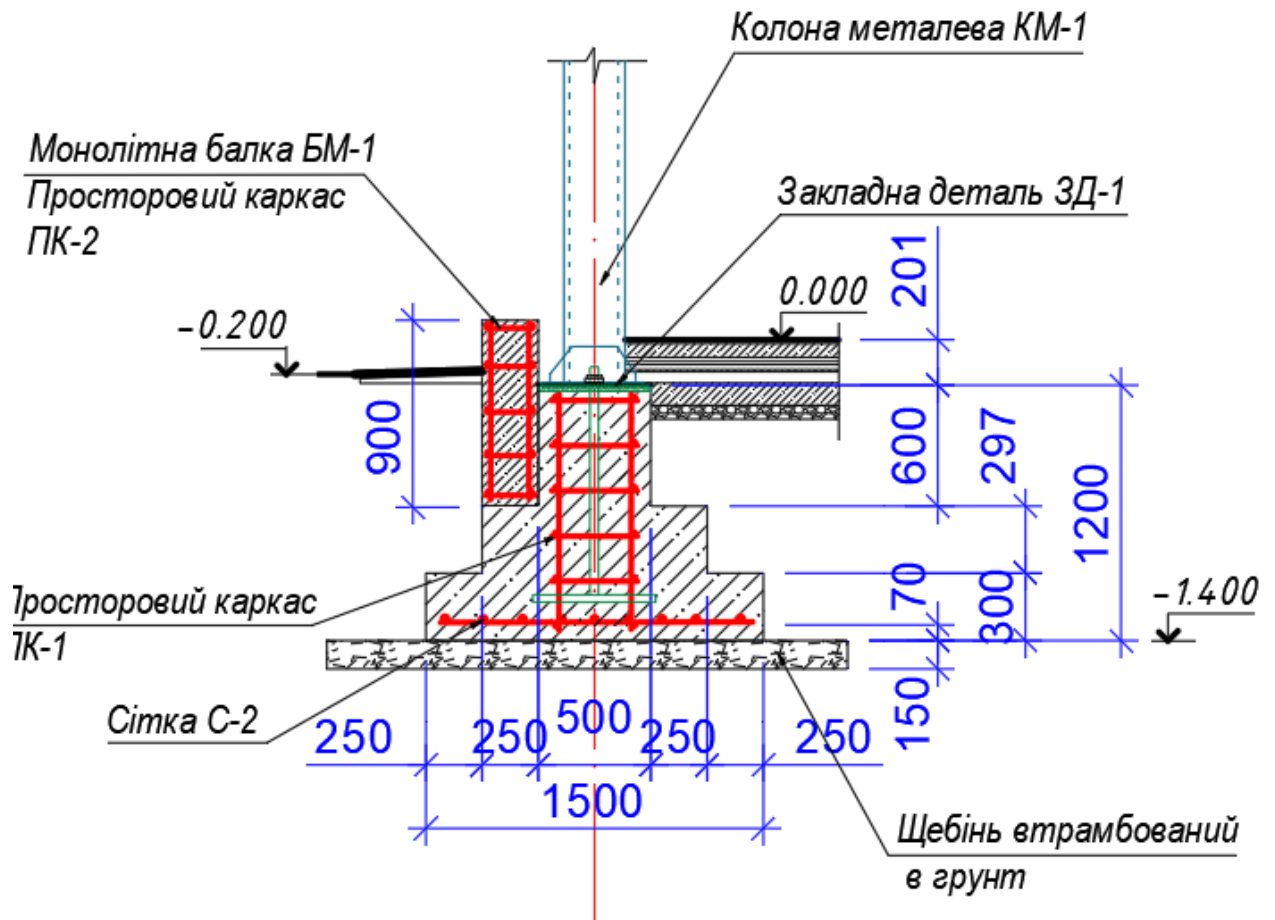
Конструкція фундаменту під колону крайнього ряду
